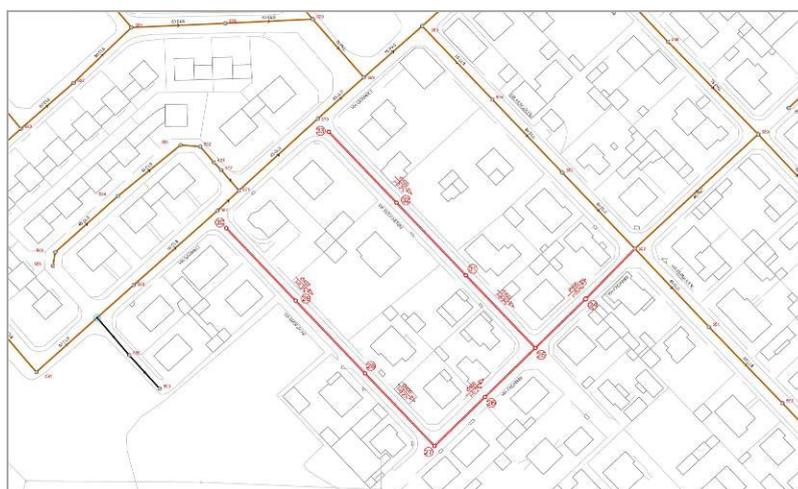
Planimetria di progetto nelle vie Mascagni, Boccherini e Paganini
